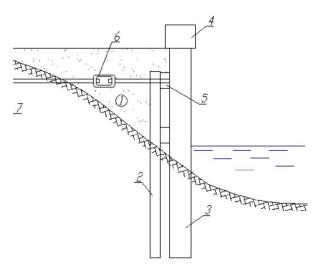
Шпунтовая стенка из свай шпунтовых композитно-полиуретановых с анкерным креплением: 1 - массив грунта; 2 – кондуктор; 3 - КШС; 4 - шапочный брус; 5 – внутренняя распределительная балка; 6 -анкерная тяга с талрепом; 7 - анкерная свая (якорь).
